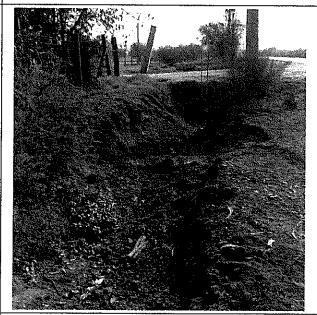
Alcantarilla sin su sección libre en un 90%, kilómetro 18, camino rol G-18. (20-08-2013)
